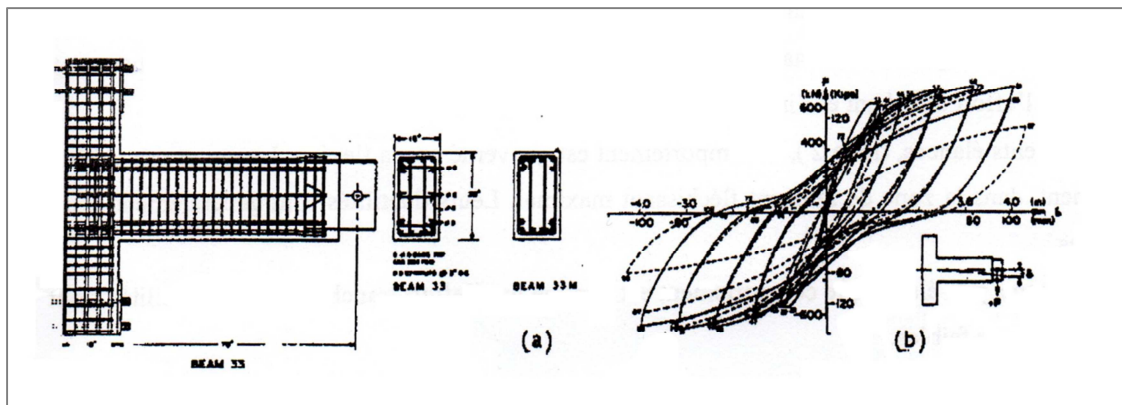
(a) Poutre ferrailée normalement. (b) Boucles d'hystérésis.
